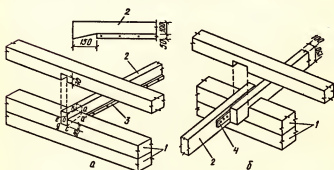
Схемы сопряжения балок перекрытия с брусьями
